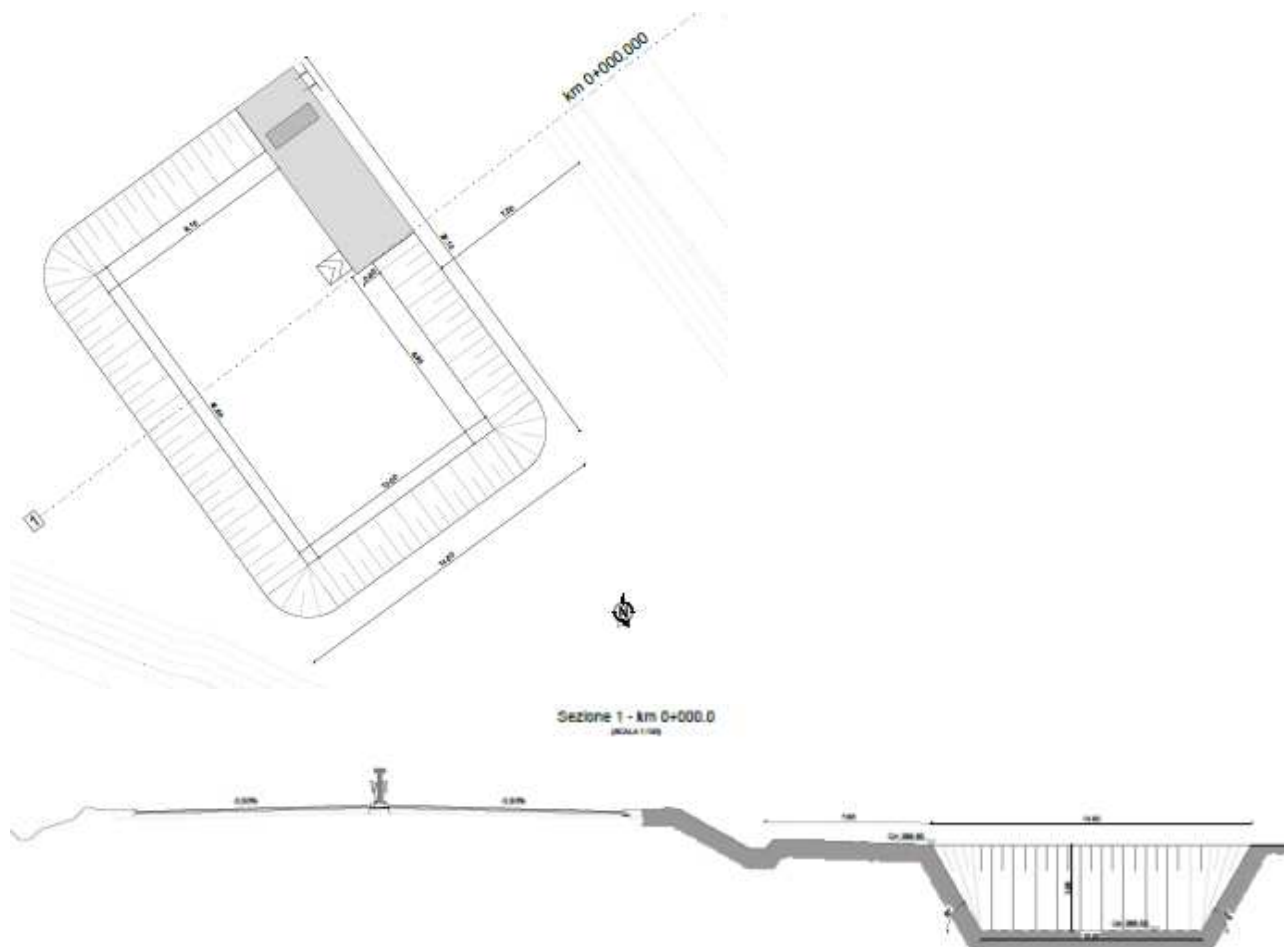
Vasca di 1° pioggia TA.1 e Vasca di Laminazione VP.1 - Stralcio planimetrico e Sezione
